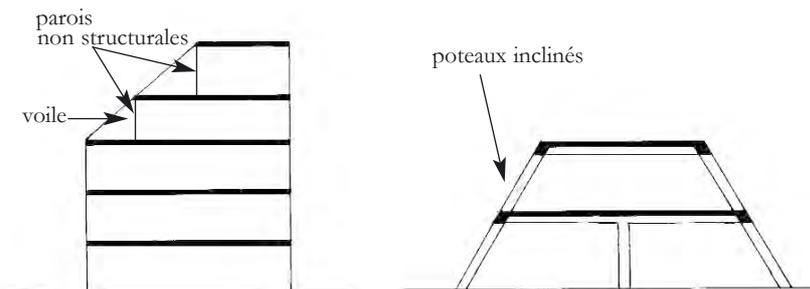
Retrait progressif de la structure. Les angles rentrants sont formés par des parois non structurales.
